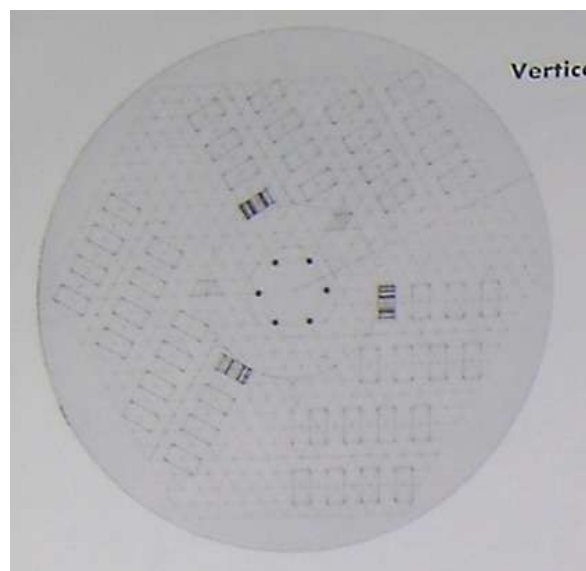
Planta de la fábrica textil de Fuller, 1951.
